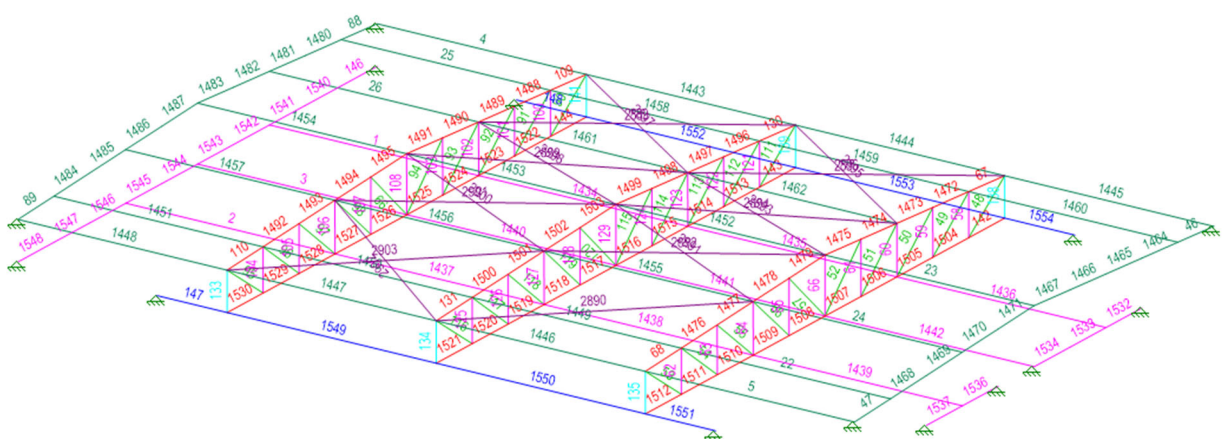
BARRAS DA COBERTURA BLOCO LIGAÇÃO
